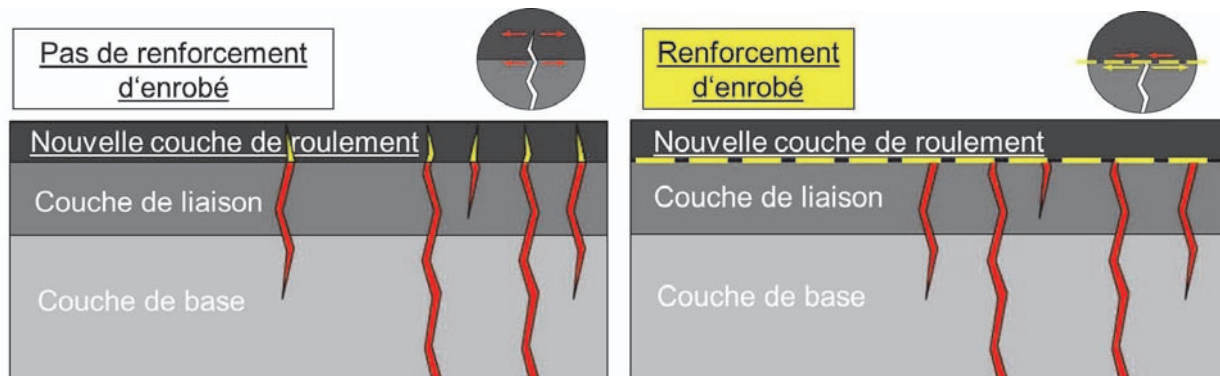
Propagation des fissures réfléchives dans les chaussées non renforcées (gauche) et renforcées (droite)
